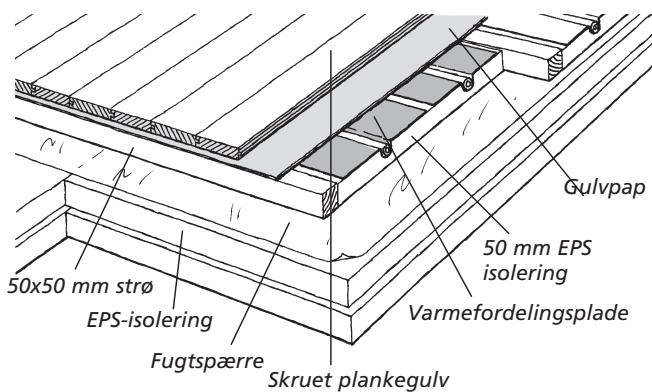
Tegningen viser strøkonstruktion med gulvvarme lagt på isolerede varmeplader udlagt mellem strøer.
